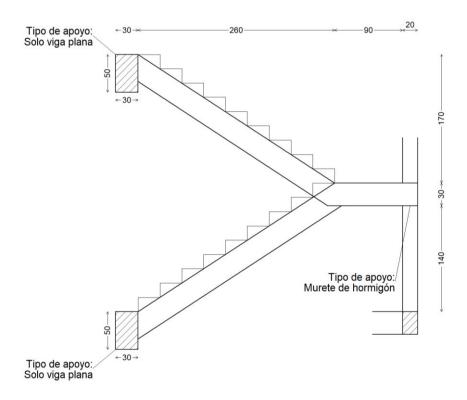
Sección acotada escalera. Fuente: CYPE 2019
